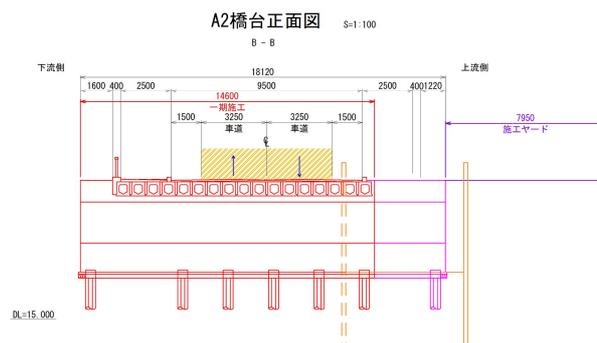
施工ステップ正面図 (下部工構築 A2 橋台時)
